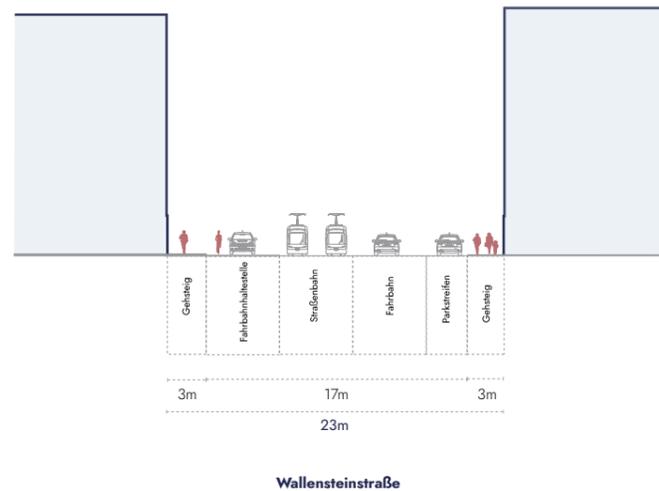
Straßenquerschnitt der Wallensteinstraße, M 1:500. Quelle: Eigene Darstellung
